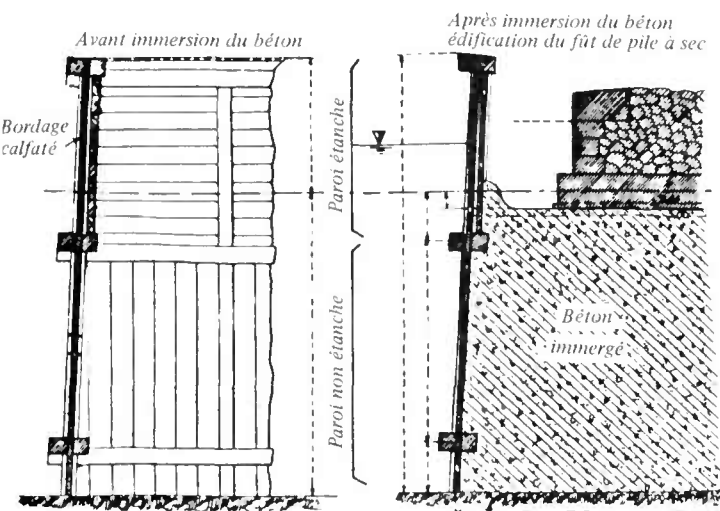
Fondation sur massif de béton immergé coulé dans un caisson sans fond.
